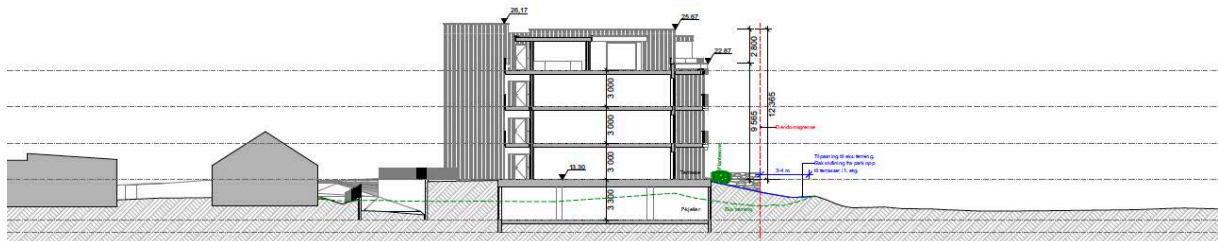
Foreløpig illustrasjon fra nordøst. Kilde: Ark BHB.
